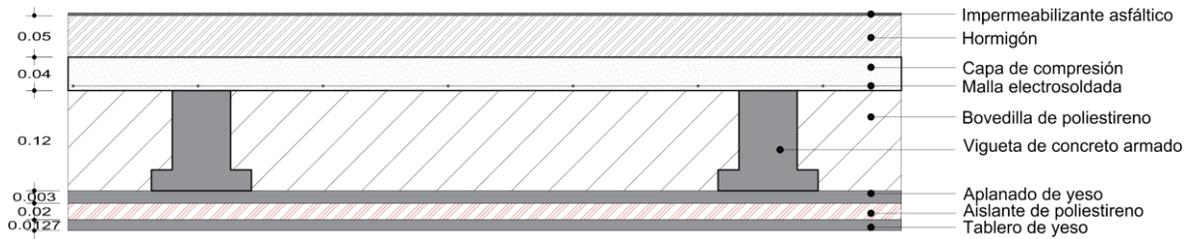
Detalle de losa con aislante de poliestireno expandido al interior (Corte)
